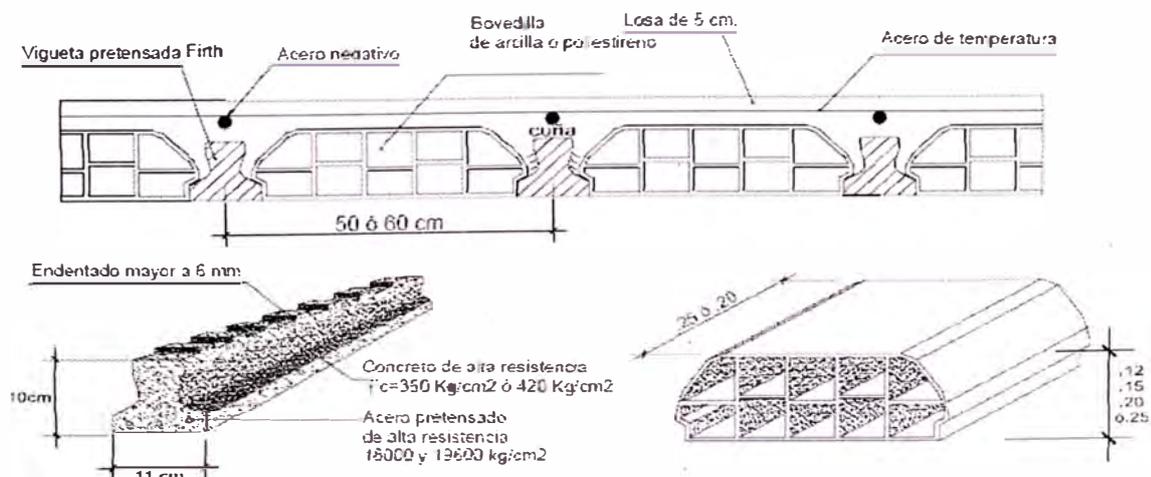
Sección de Losa Aligerada – Sistema de Viguetas Pretensadas Firth
